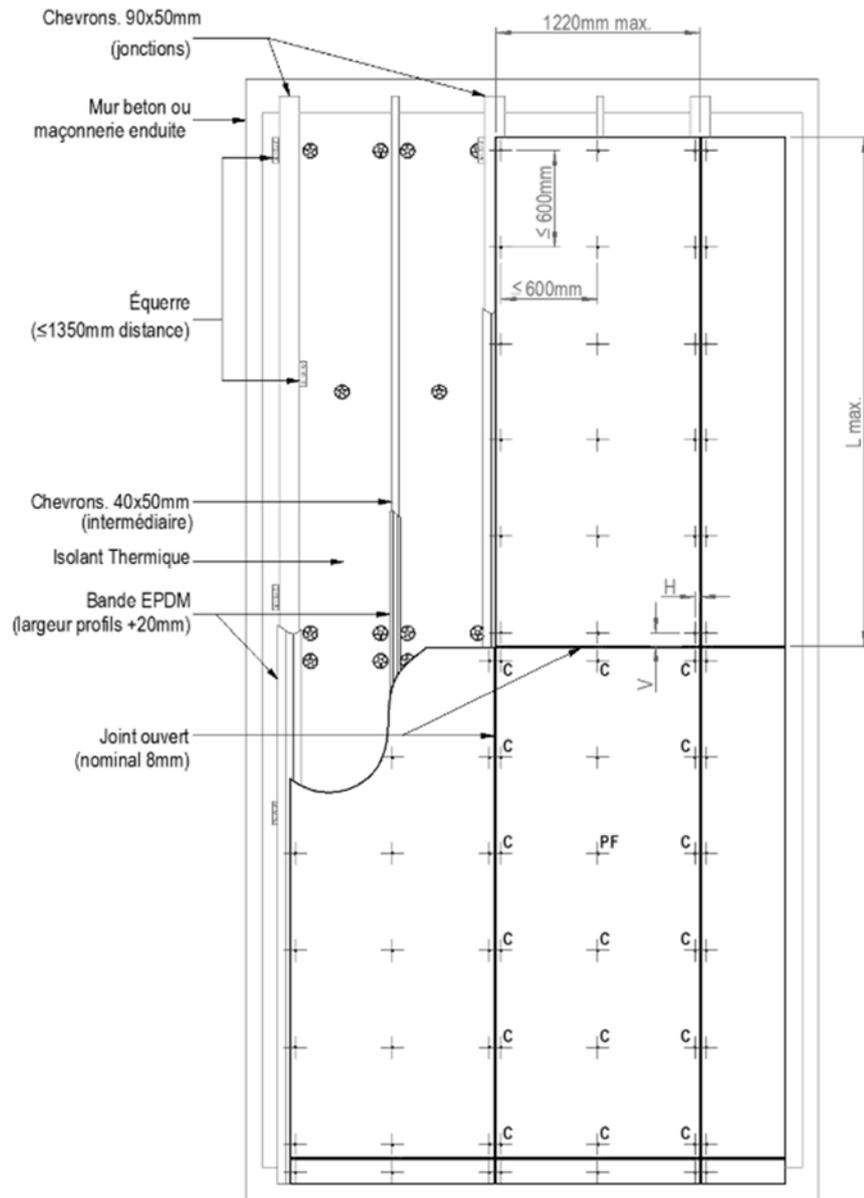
Principe de pose des fixations des plaques sur ossature bois
